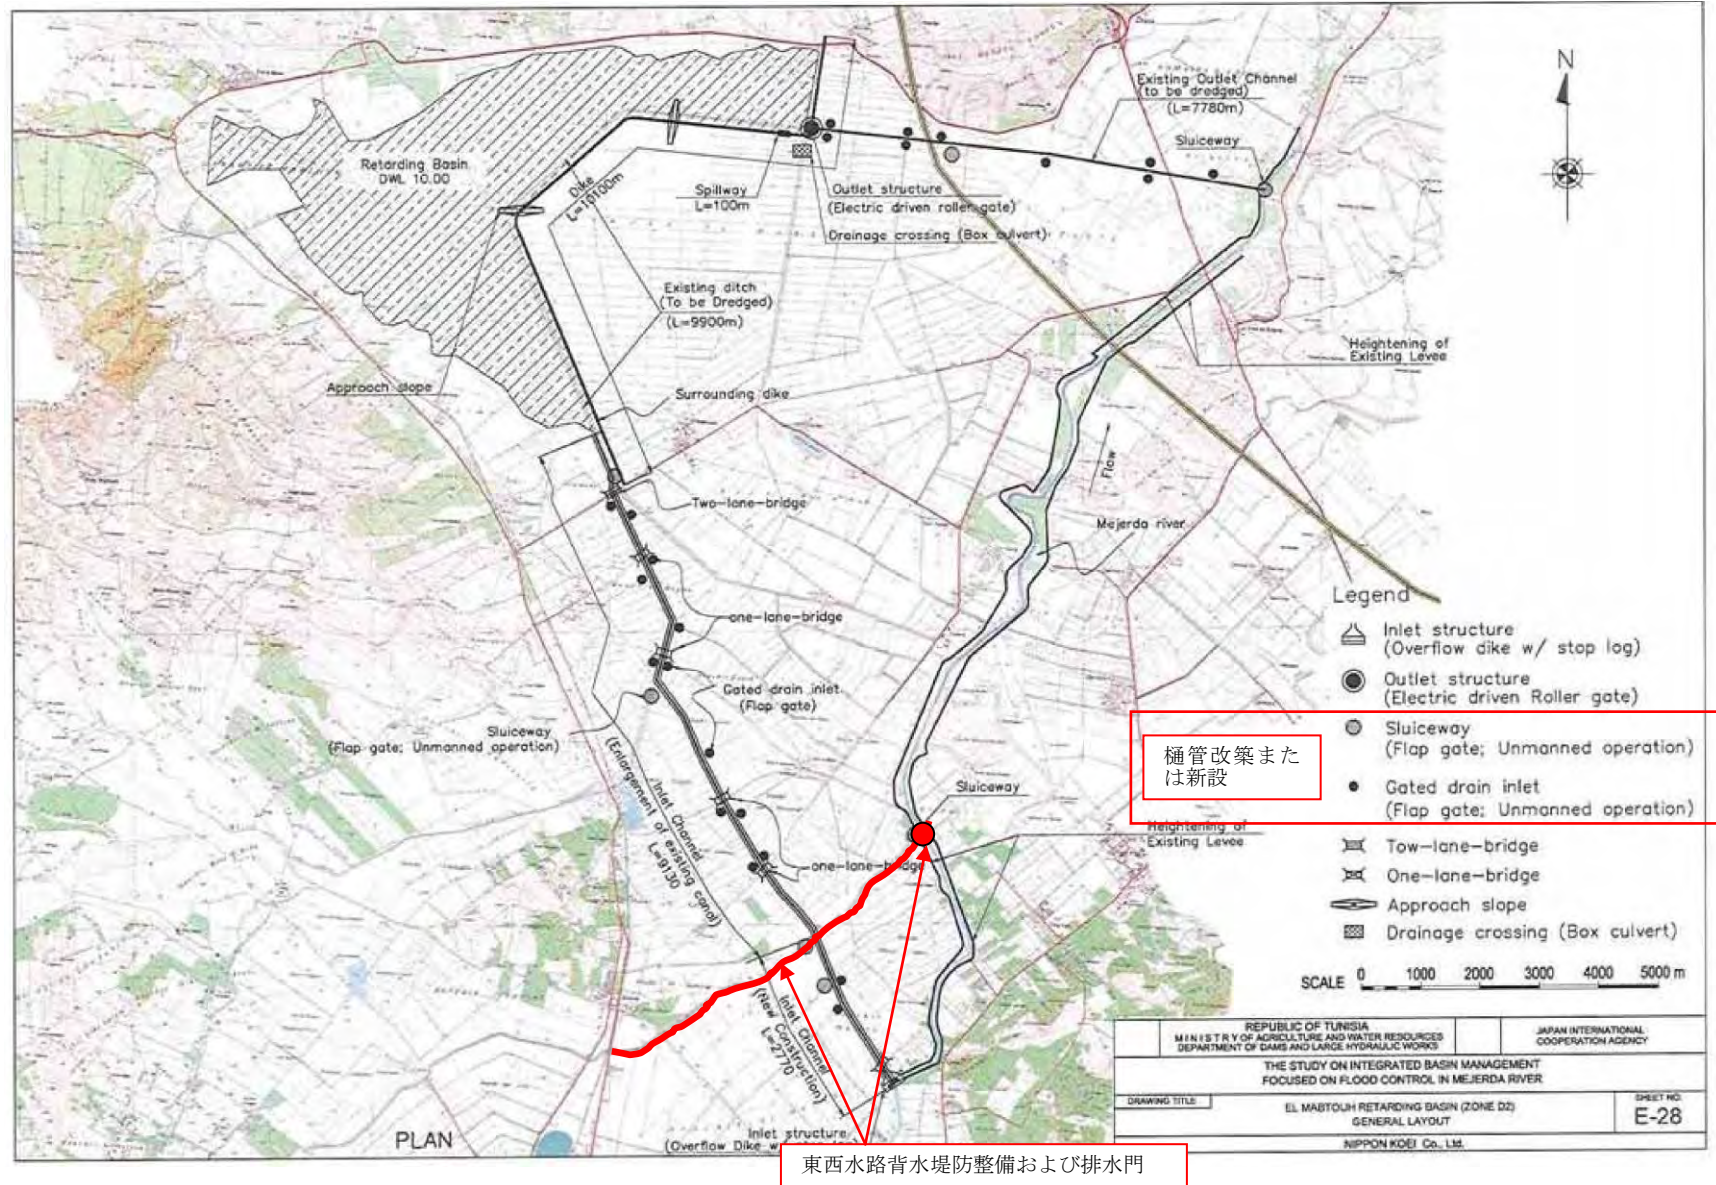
合流点付近の水路と新設排水門断面と構造一般図
